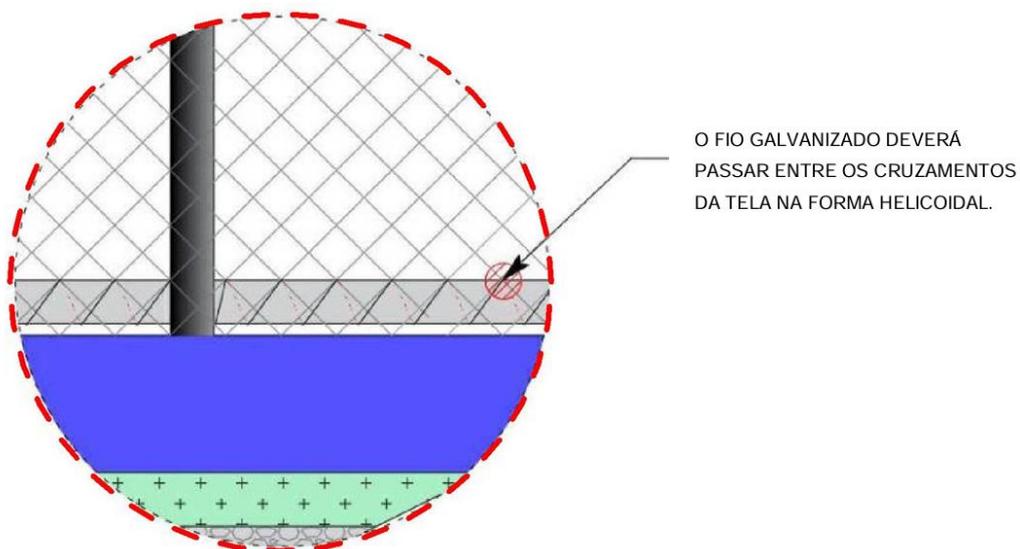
Detalhe da fixação das telas (Fonte: Autor/2023)
